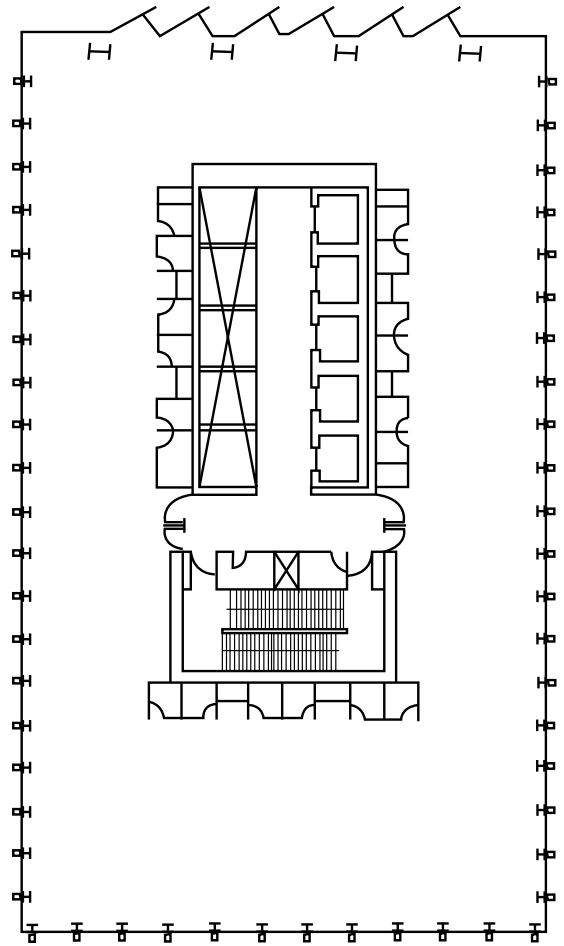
Planimetría de la Nueva Torre Santa María. Fuente de: Elaboración propia.
